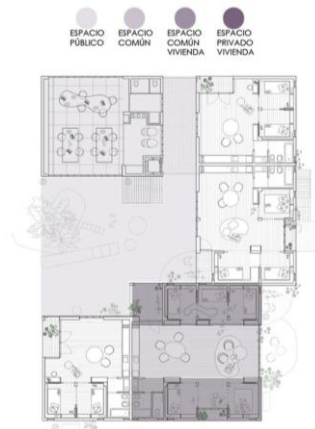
Recorte de la planta del conjunto de vivienda colectiva, indicando en color la herramienta utilizada. Fuente: Elaboración propia.
